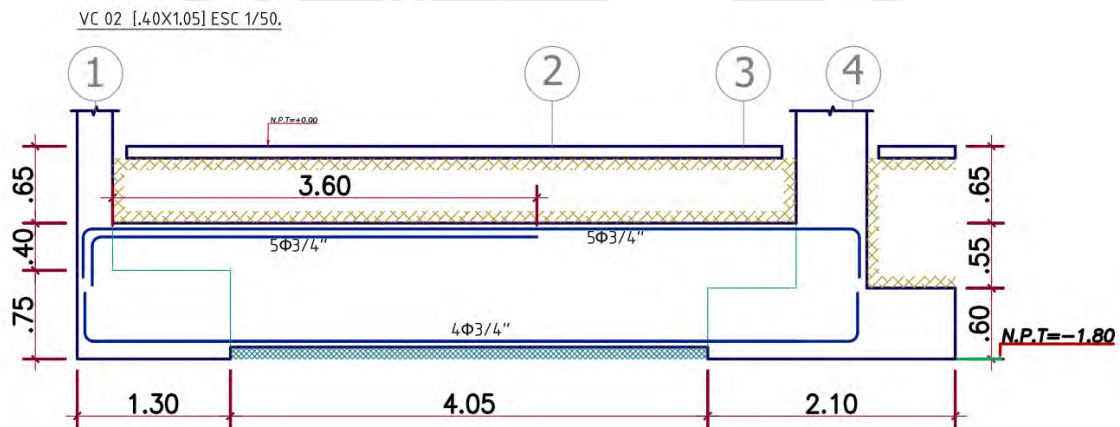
Armadura seleccionada para la Viga de Cimentación VC 02.
